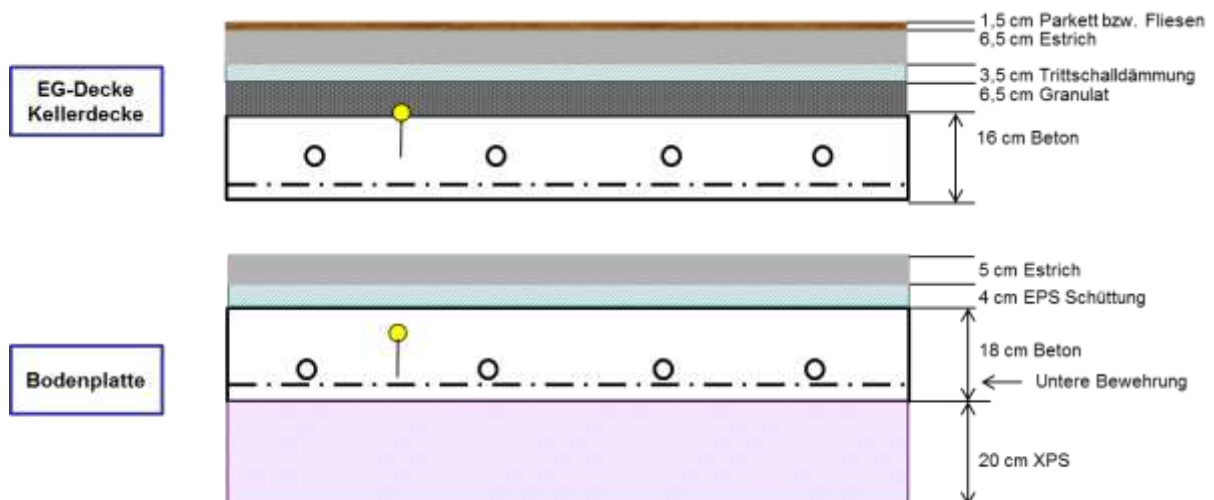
Aufbau der bauteilaktivierten Bodenplatte bzw. der Zwischendecken (Kellerdecke, EG-Decke) inkl. Fußbodenaufbau (Quelle: Planer, eigene Darstellung)
